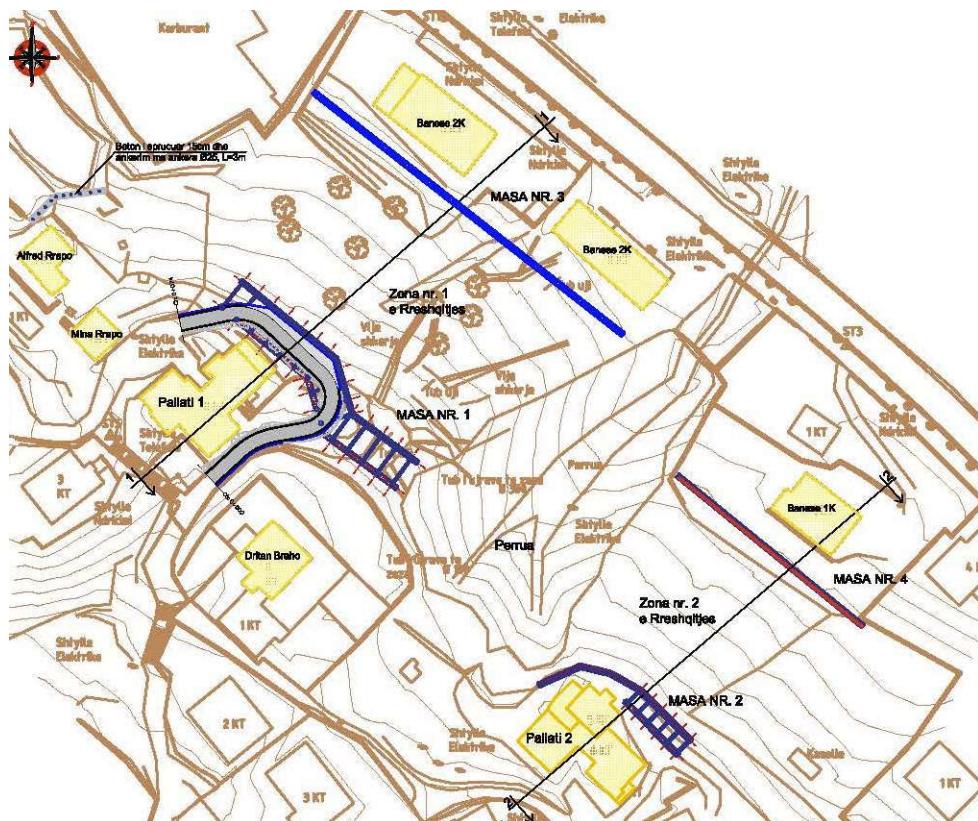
Paraqitura e zonave ku janë bërë llogaritjet në këtë report
